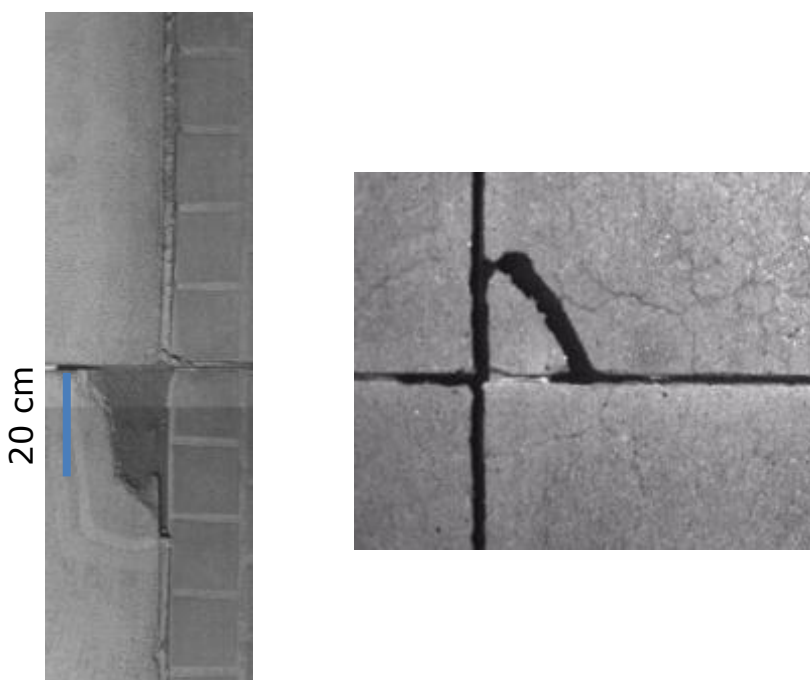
Przykład pęknięcia poprzecznego na płycie betonowej (P).
